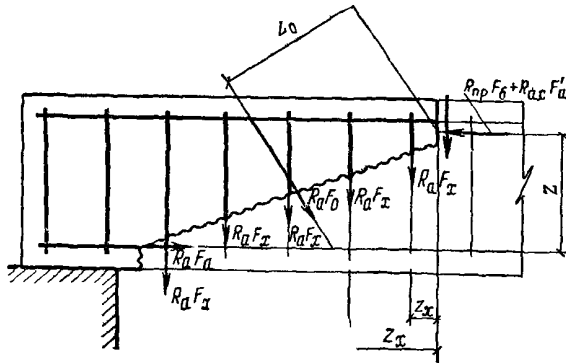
Схема усилий в сечении, наклонном к продольной оси железобетонного элемента. при расчете его по прочности на действие изгибающего момента
